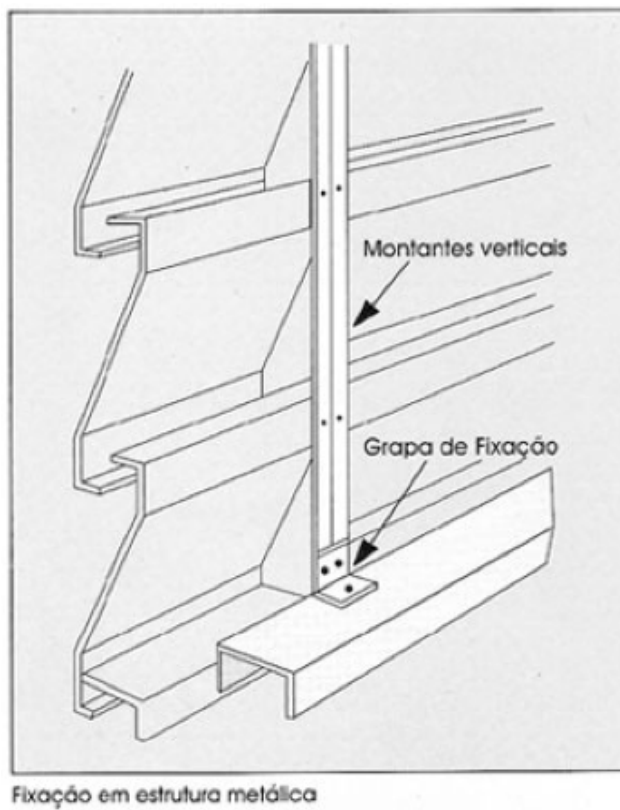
Exemplo de fixação em estrutura metálica.
